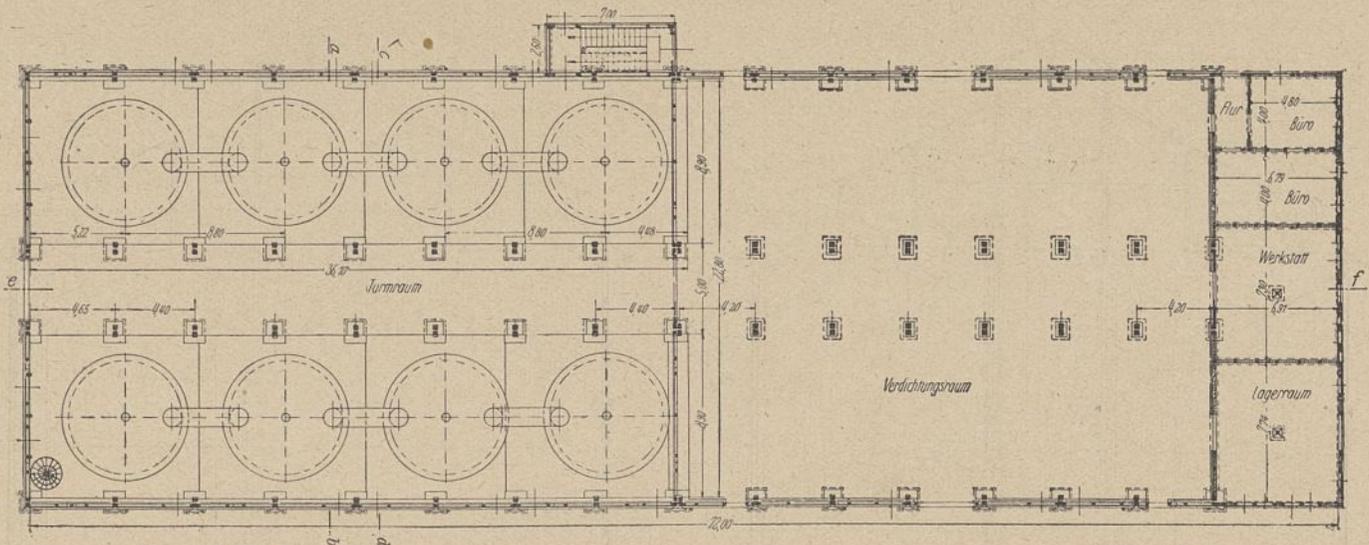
Turmhaus, Grundriß. Maßstab 1:400
